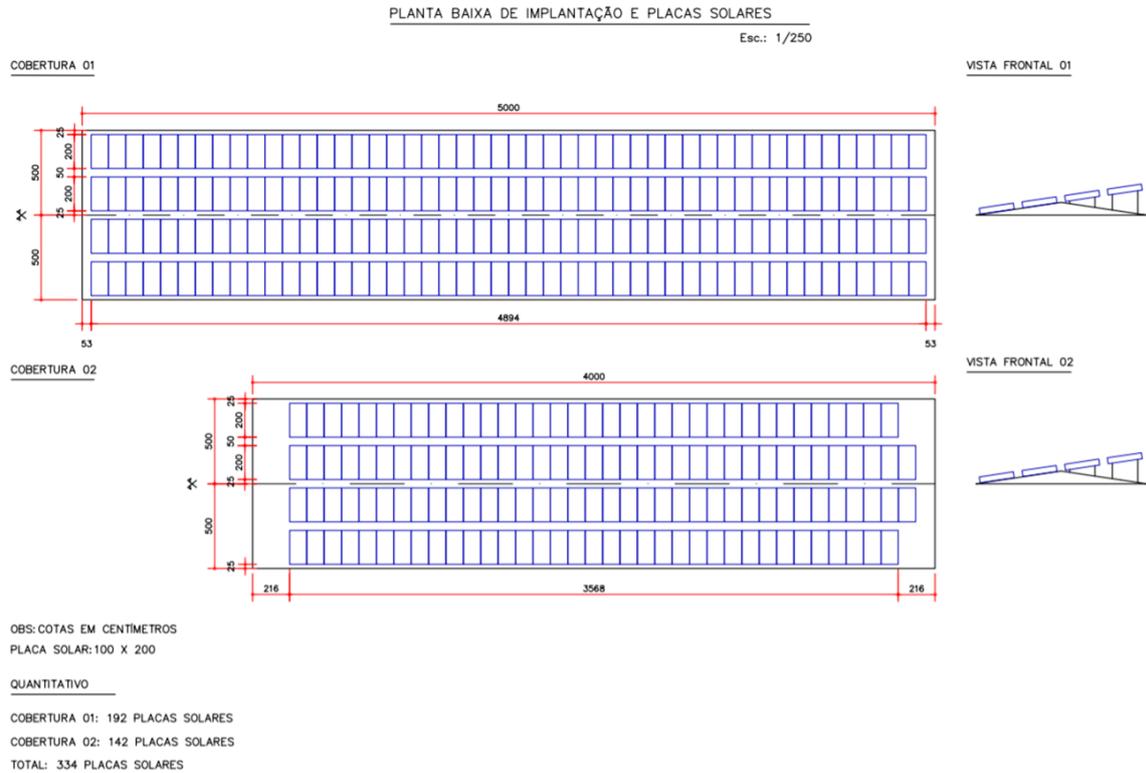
Planta baixa de implantação do arranjo fotovoltaico
